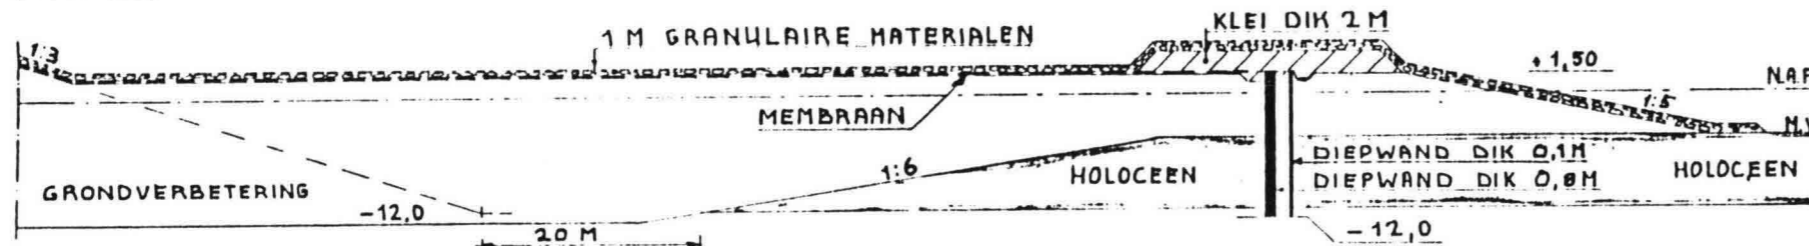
GRONDVERBETERING AANSLUITING IJSSELMEEERZIJDE
